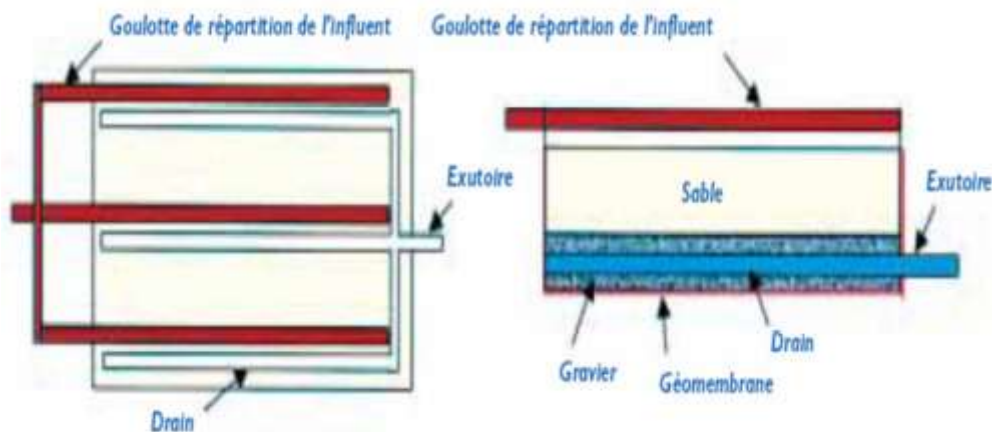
Infiltration-percolation étanchée et drainée [6]
